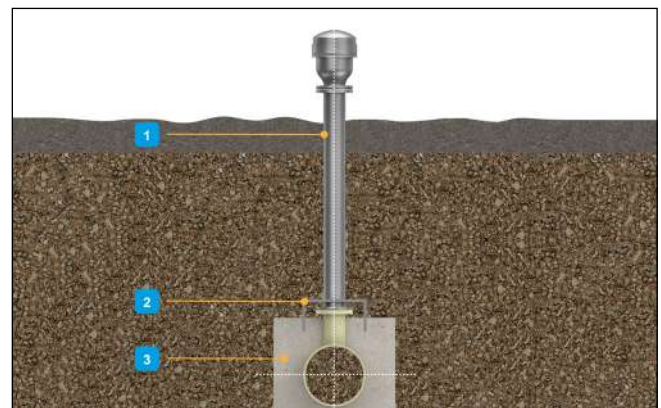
Bloco de suporte para grandes profundidades de enterramento
